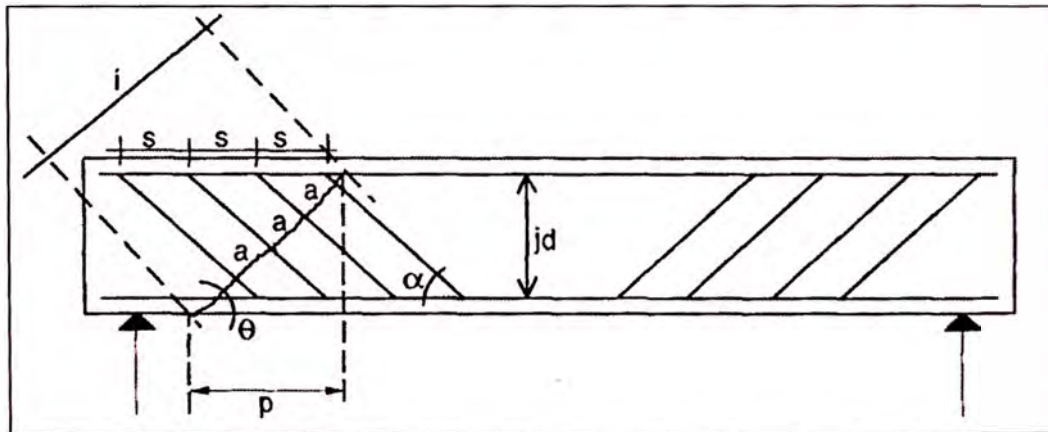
Grietas por corte en vigas Fuente: Concreto Armado – R. Morales
